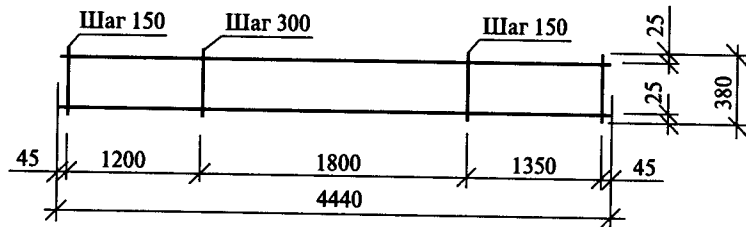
Конструкция каркаса балки — к примеру 7.9
